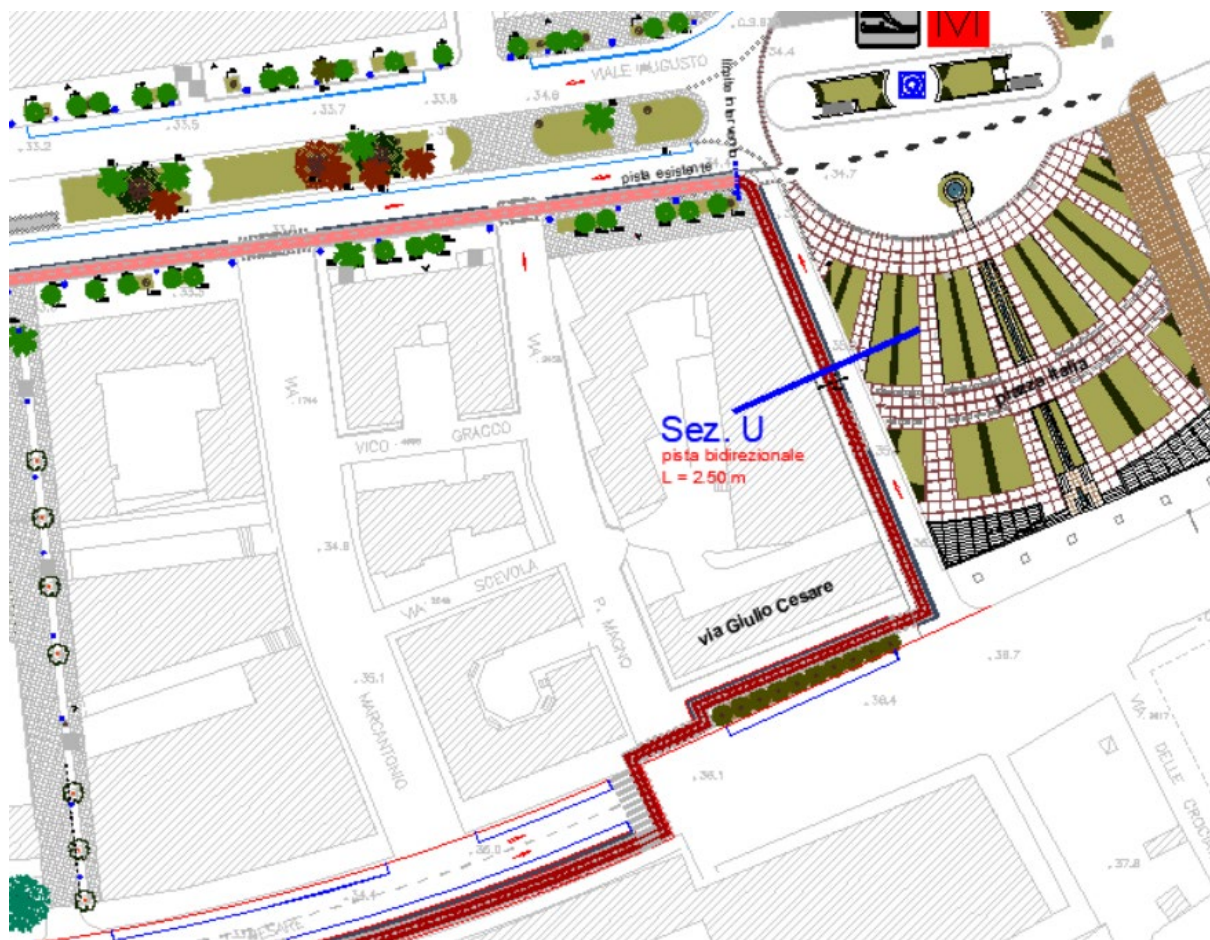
via Giulio Cesare, tratto finale – andamento planimetrico.
